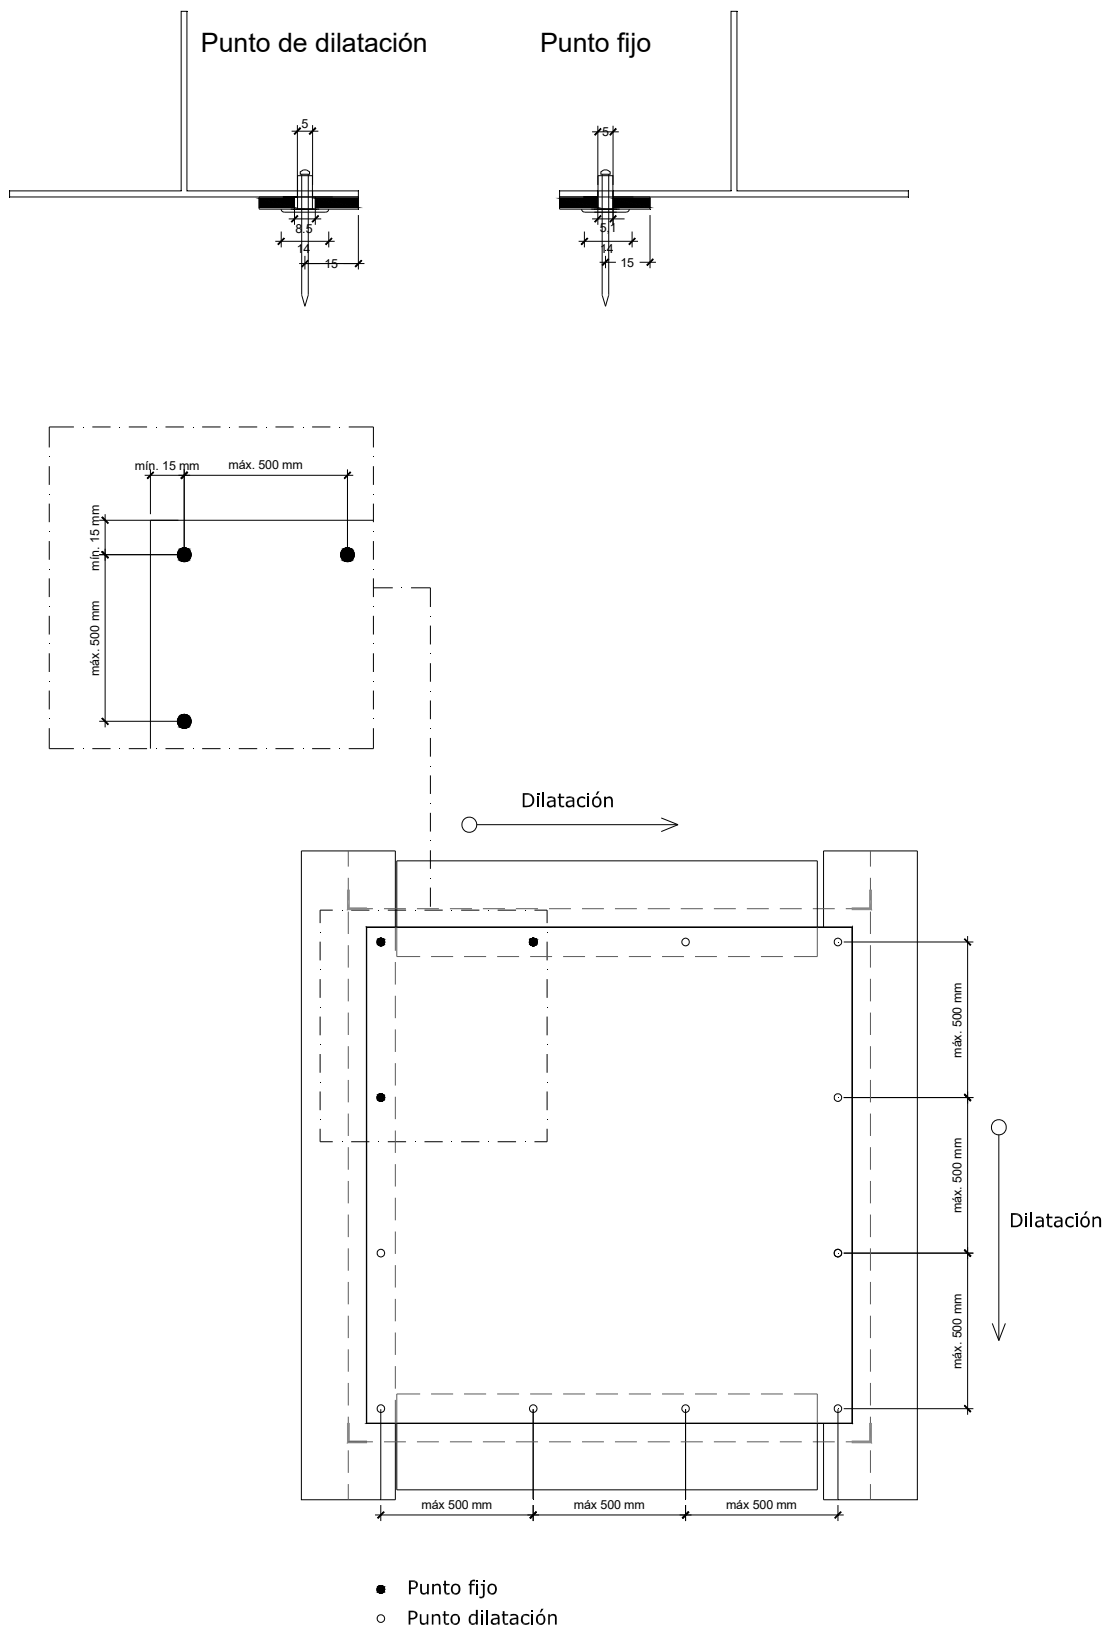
Esquemas del kit etalbond® PE/FR Riveted Boards
